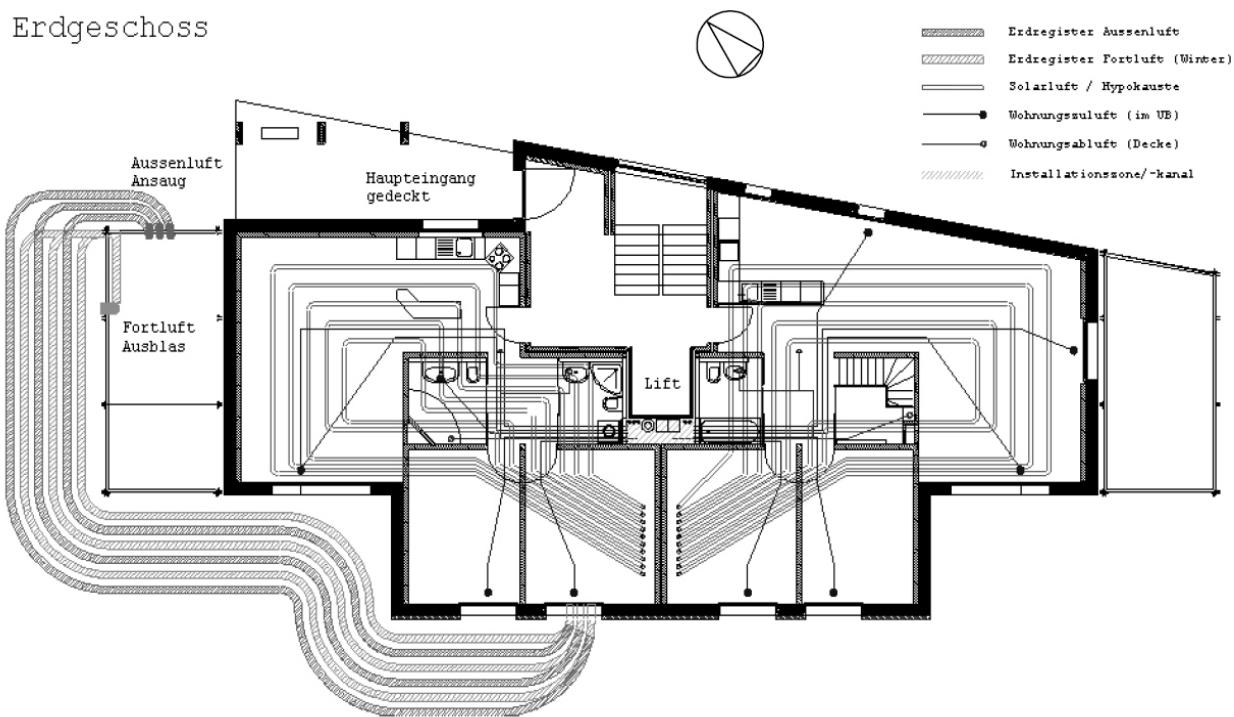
Grundriss des Erdgeschosses im Passivhaus Rychenbergstrasse in Winterthur mit integriertem Lüftungsschema [8].
